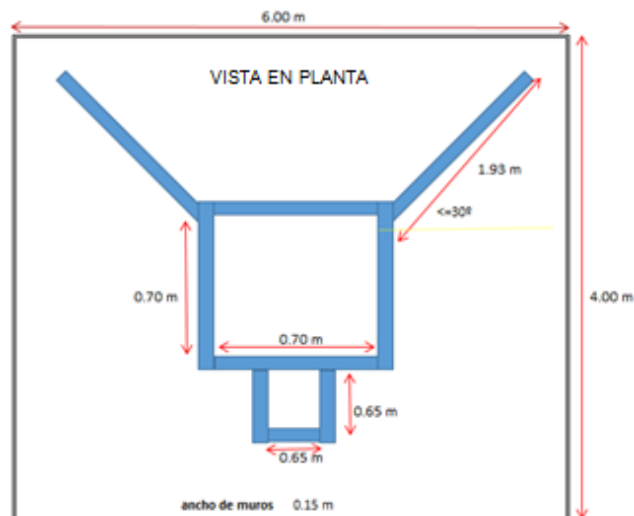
Pre dimensión hidráulica en planta de la cámara húmeda 1
